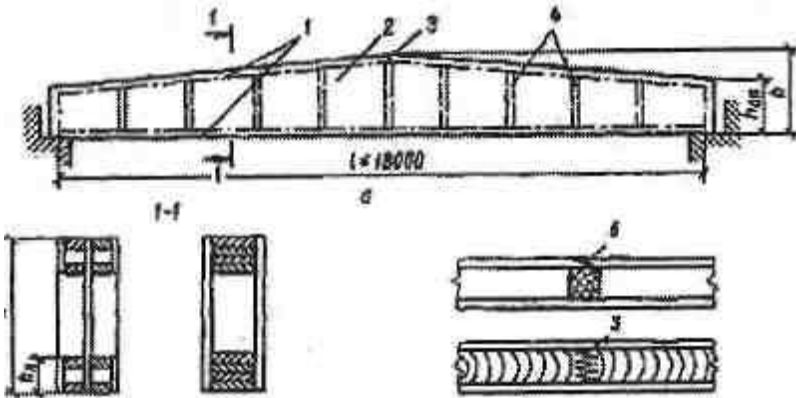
Клеєфанерна ребриста балка: а – загальний вигляд; б – двотавровий переріз; в – коробчастий переріз; г – дощаті пояси
